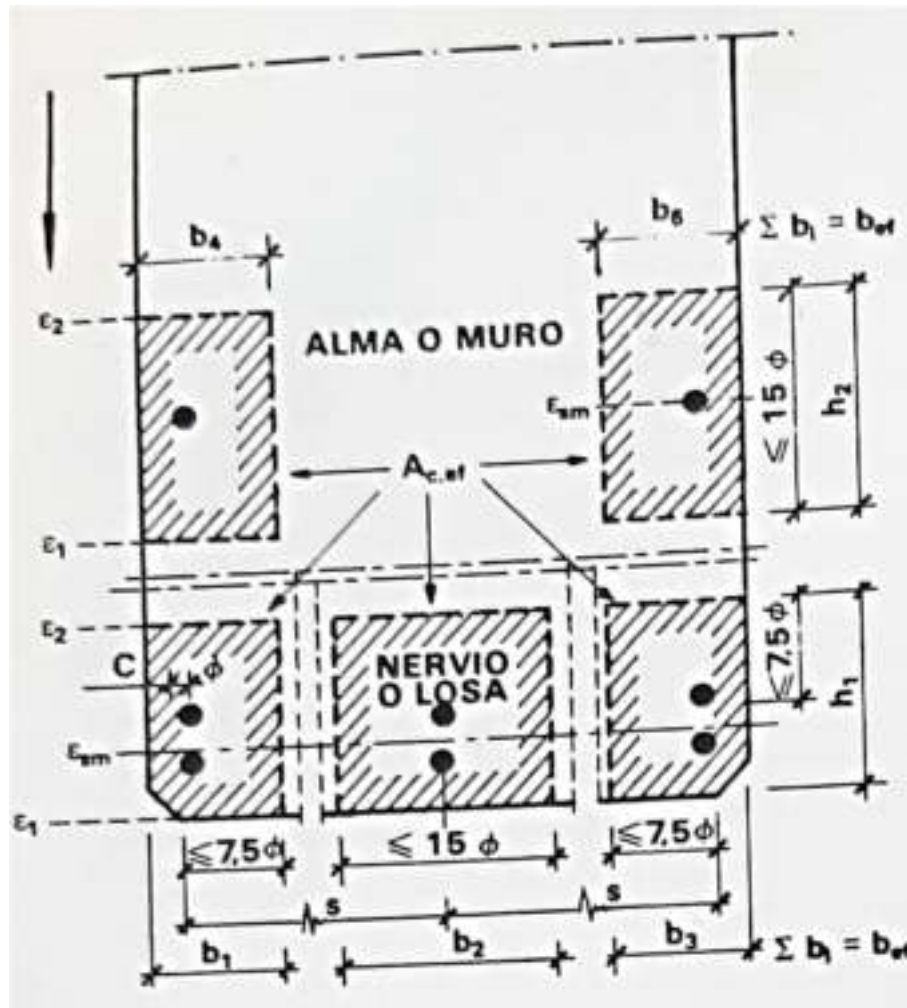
Fisuración en elementos de Hormigón Armado.
